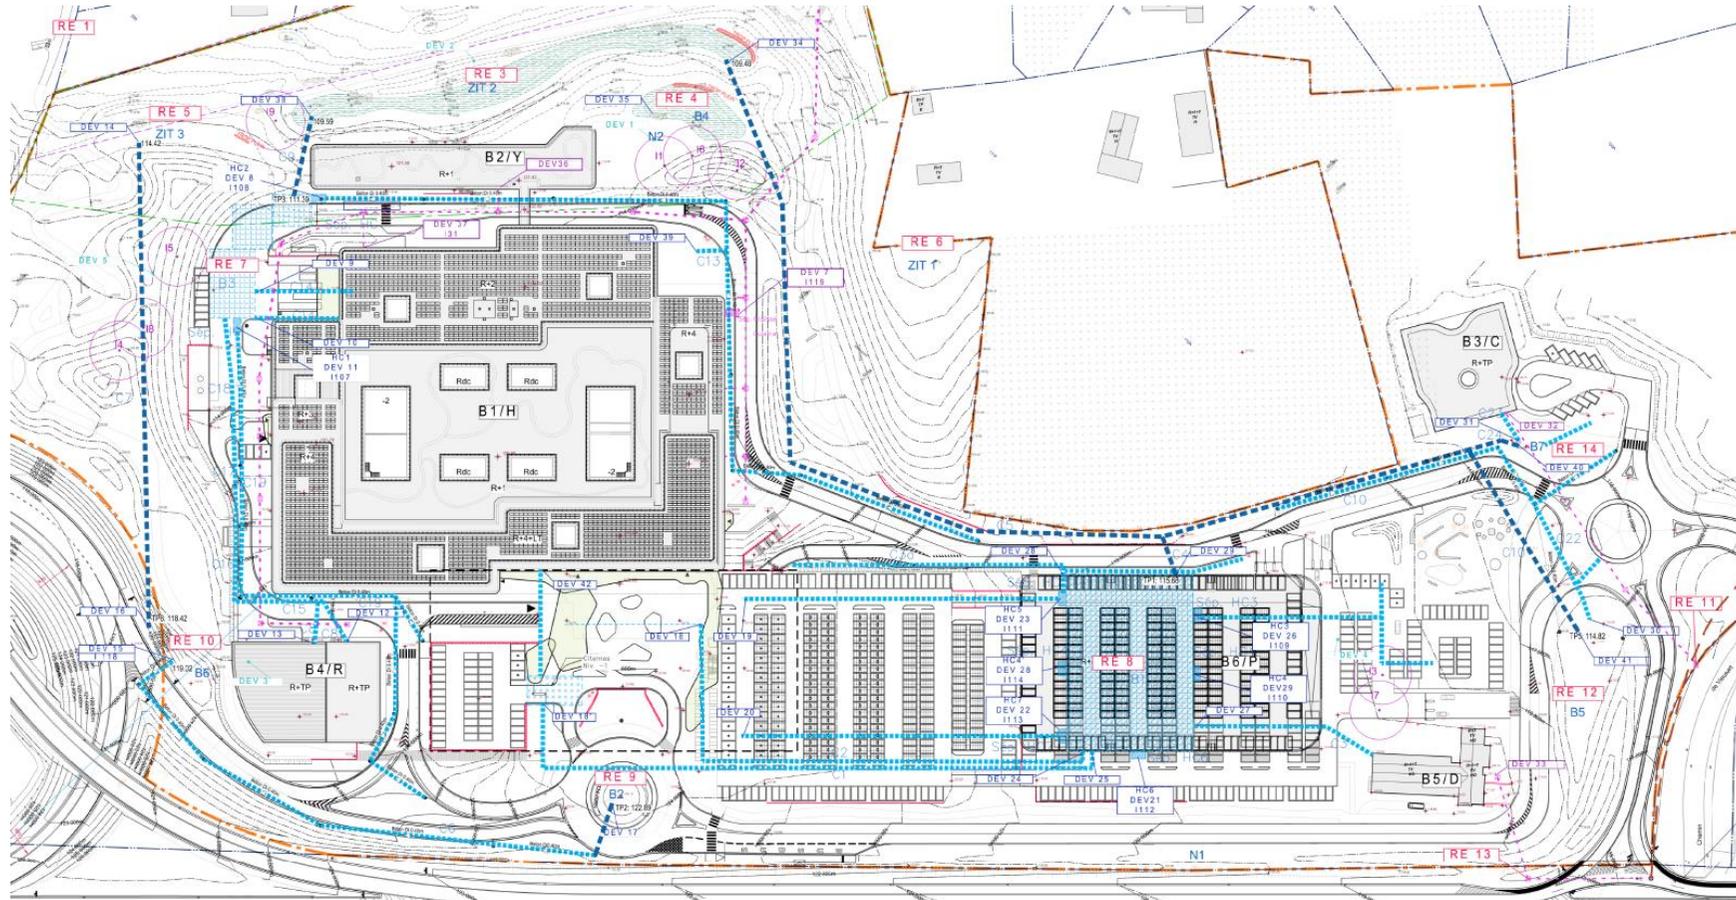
Plan d'implantation des bassins, ZIT, conduites et noue
